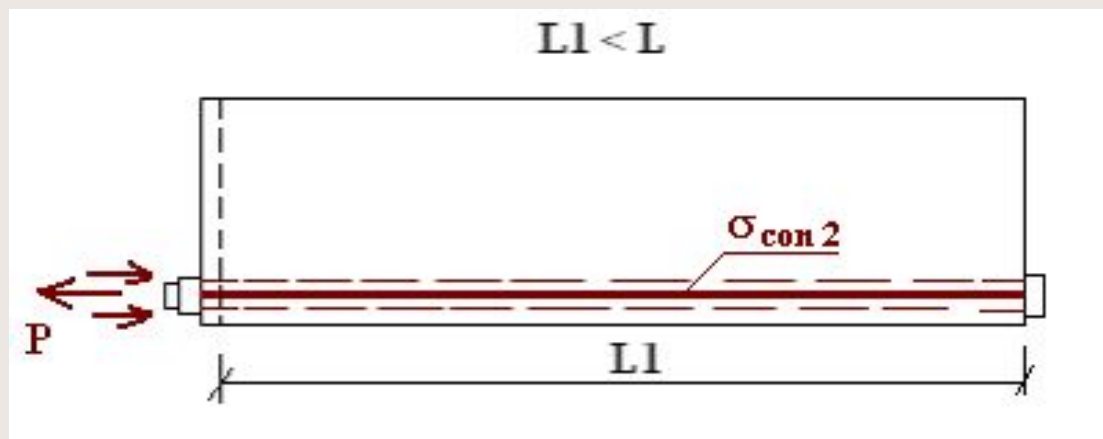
Контролируемое напряжение в арматуре при натяжении на бетон
